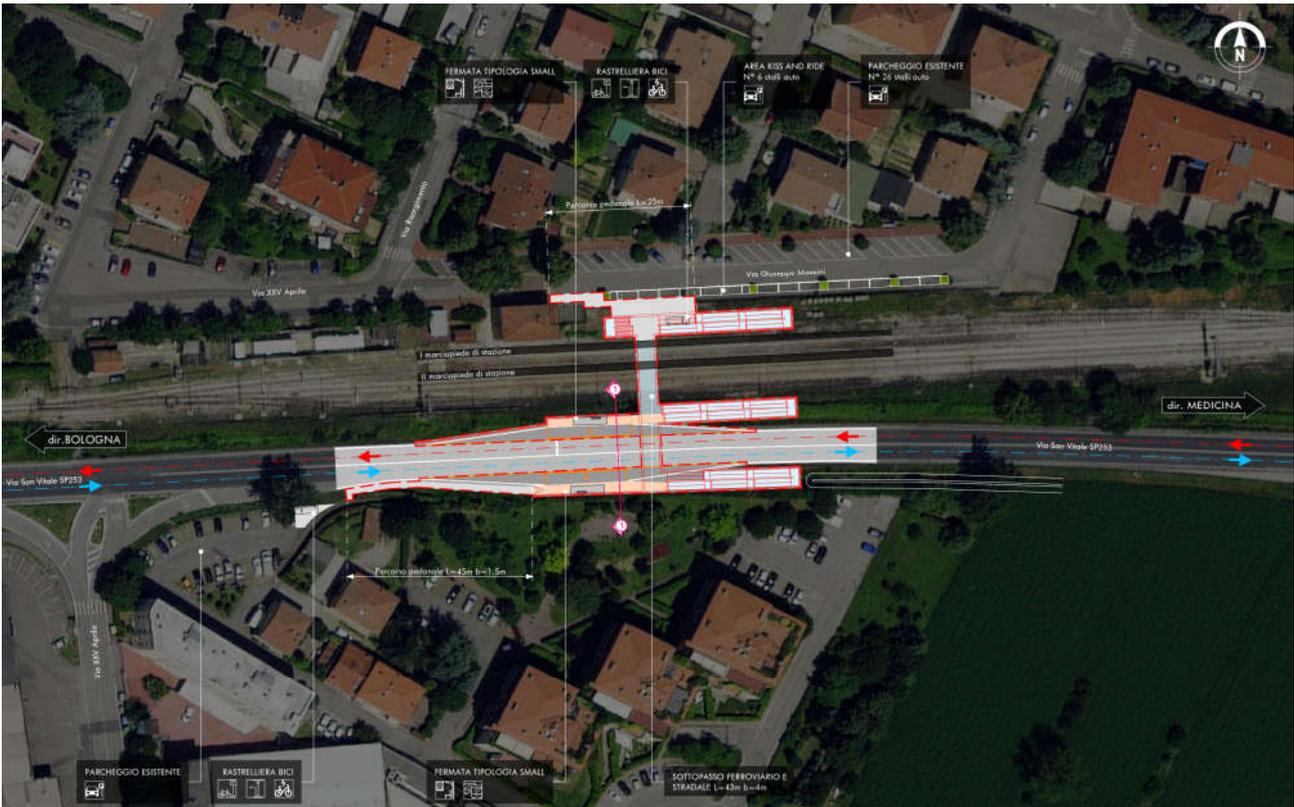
Fermata Castenaso Stellina. Planimetria.
